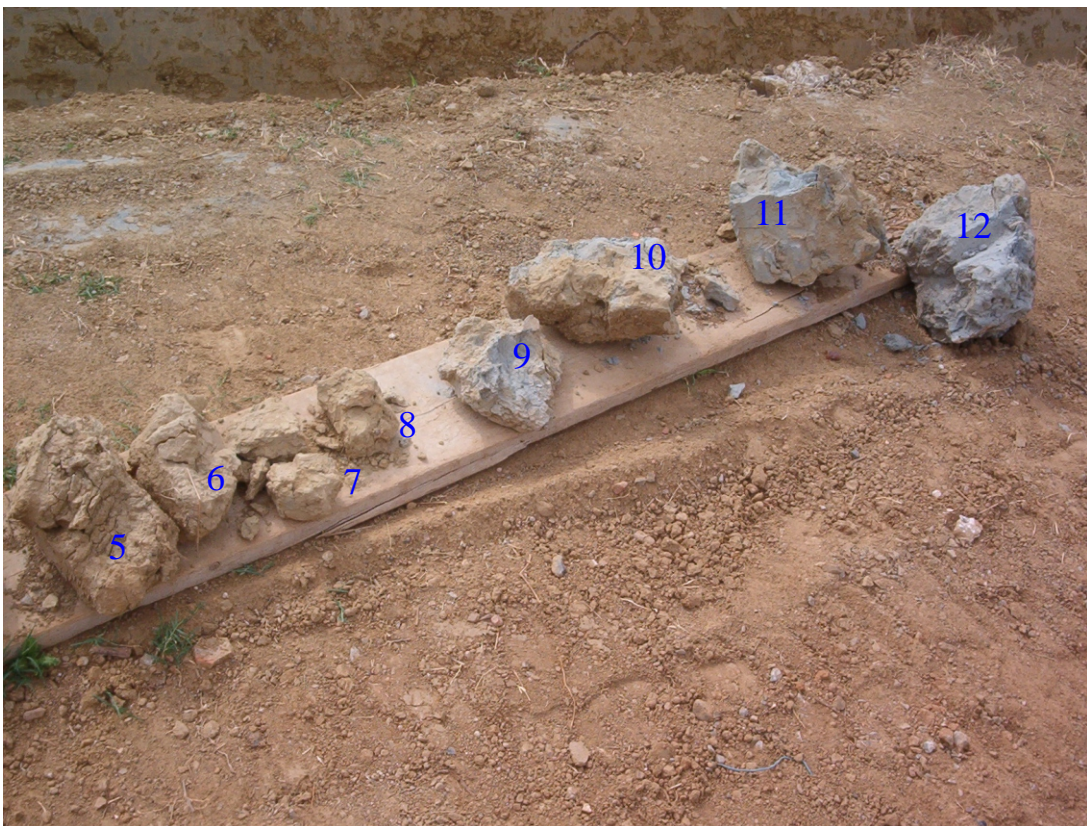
Sondaggio. Zolle n°5-12 (profondità 7,5-18 m).
